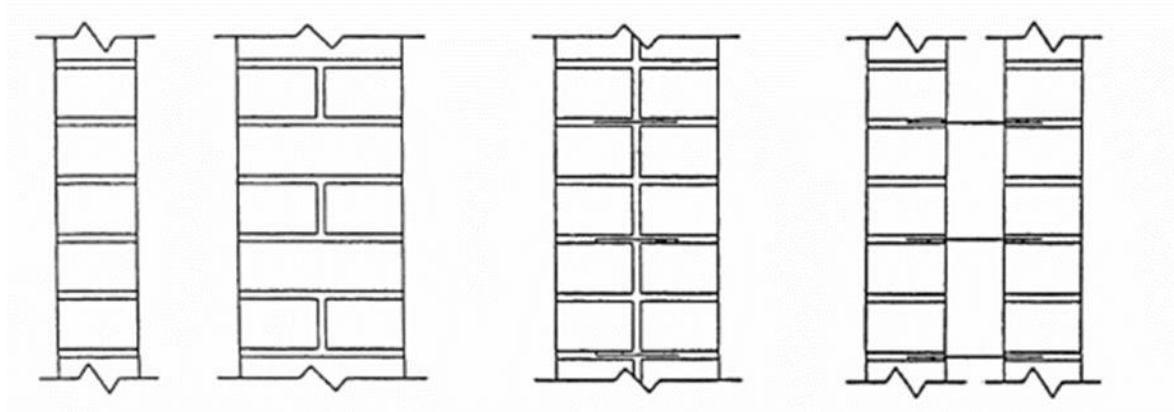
Sistemet e konstruksioneve me mure mbajtëse masive
